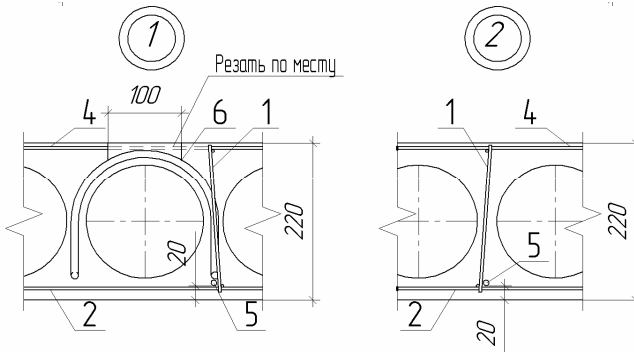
Узел 1 – расположение строповочной петли; узел 2 – крепление сеток к каркасу с поперечной арматурой (обозначение см. рис. 3.5)
